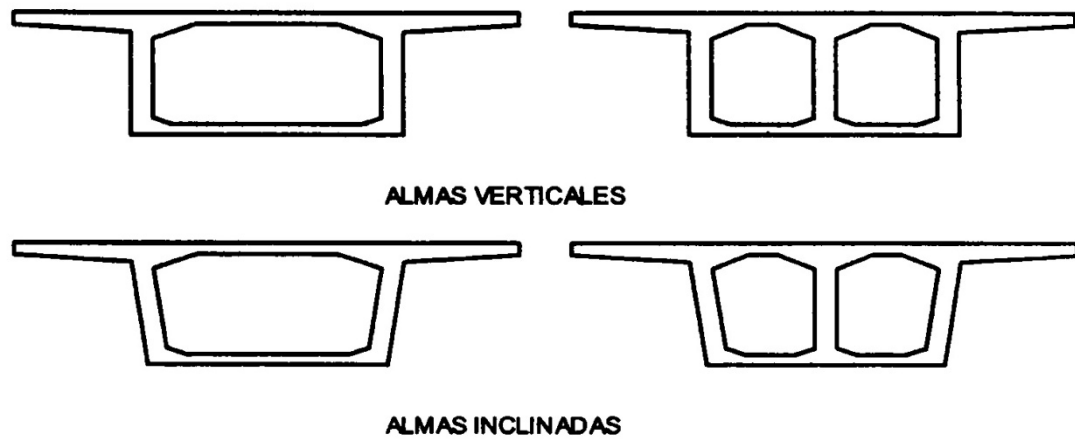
Secciones transversales típicas (Fuente: Ministerio de Fomento 2000)
